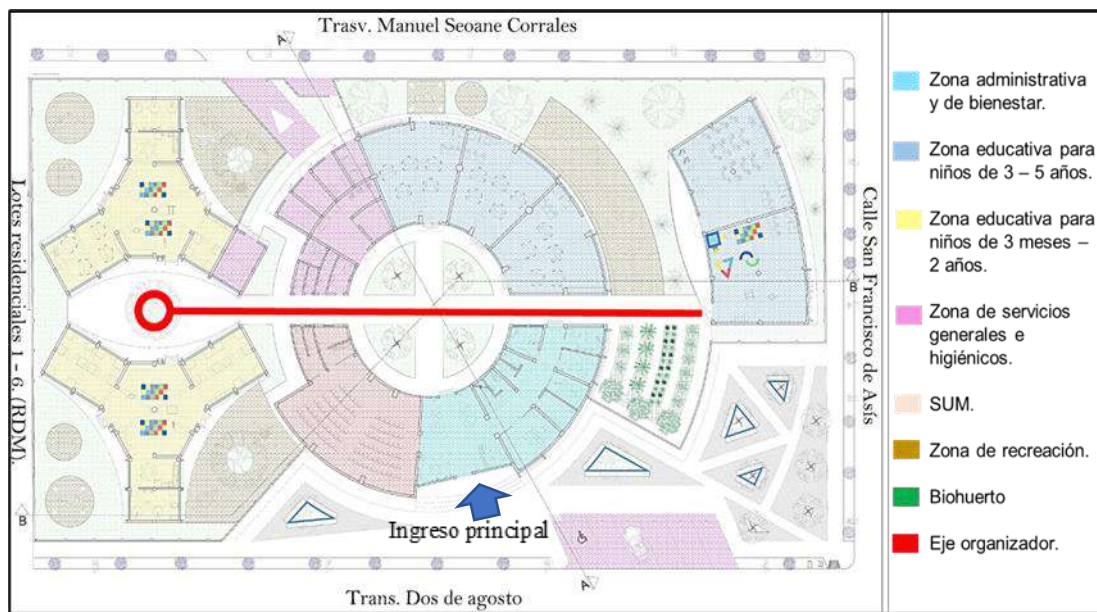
Planta arquitectónica primer nivel de la Cuna Jardín.
